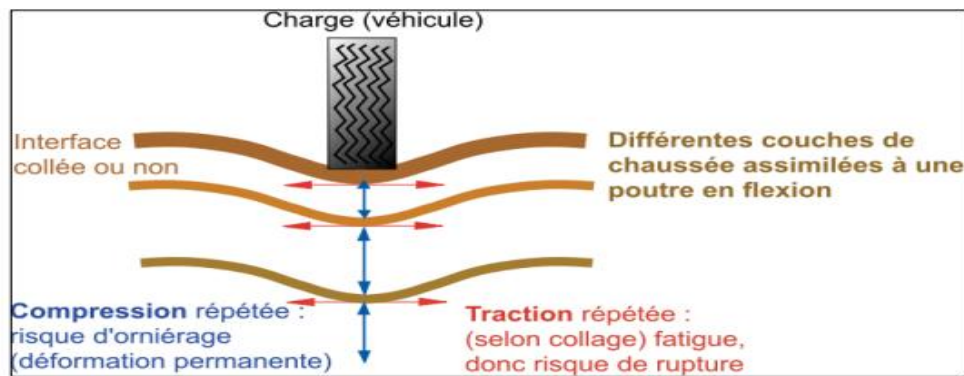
Schéma de fonctionnement d'une structure de chaussée sous l'application d'une charge roulante.
